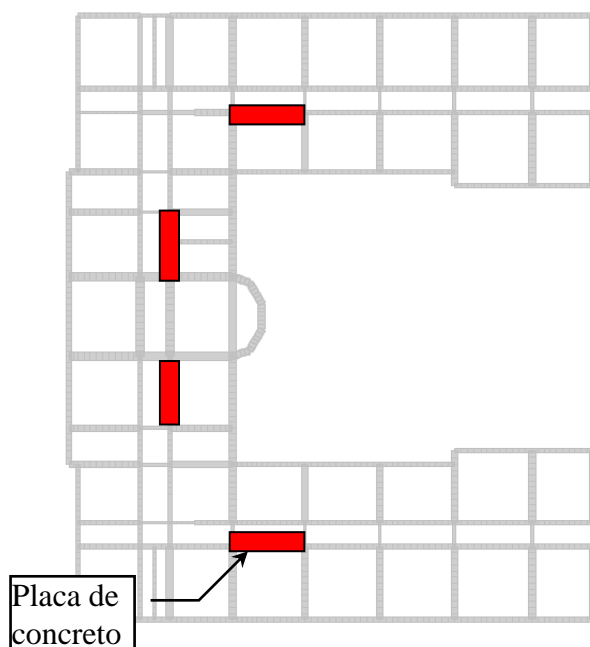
Esquema de reforzamiento con placas y separación de muros de las columnas –Bloque A.
